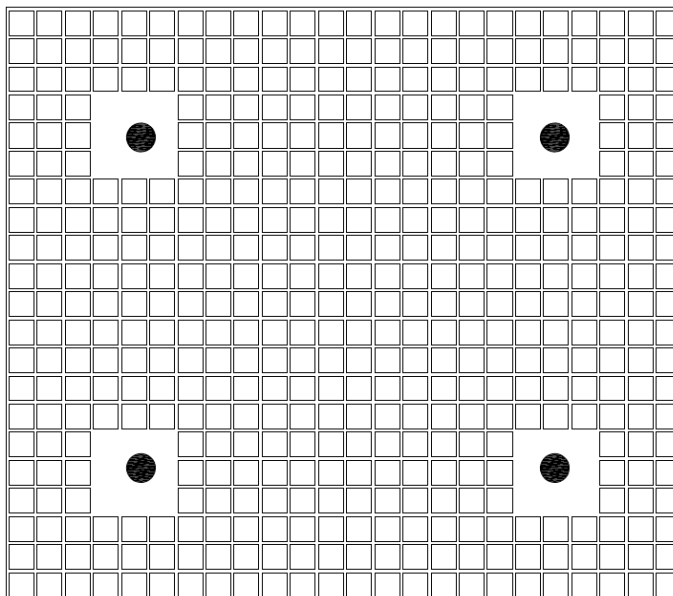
Trecho da laje para cálculo da espessura média de concreto
